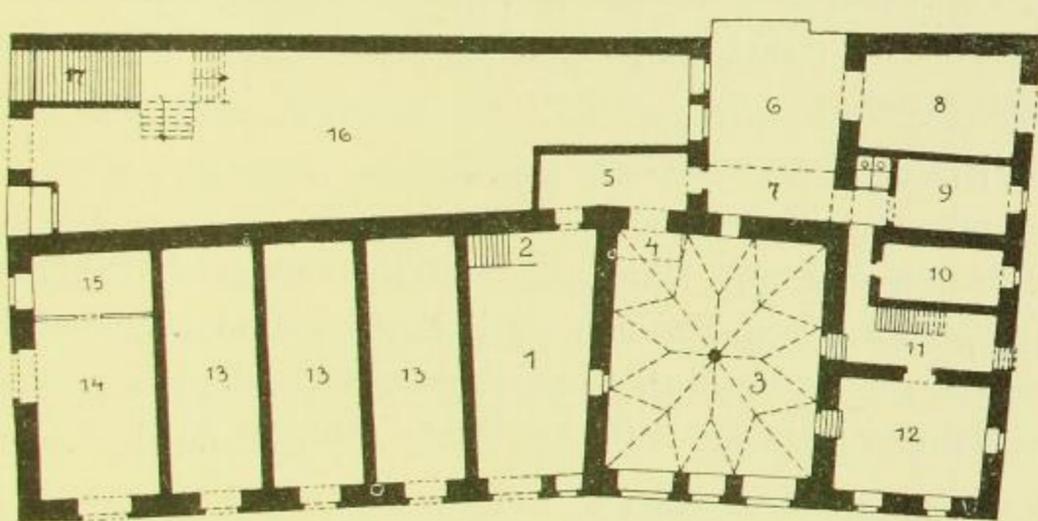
Grundriß des 1882 abgebrochenen Gewandhauses. Erdgeschöß.
